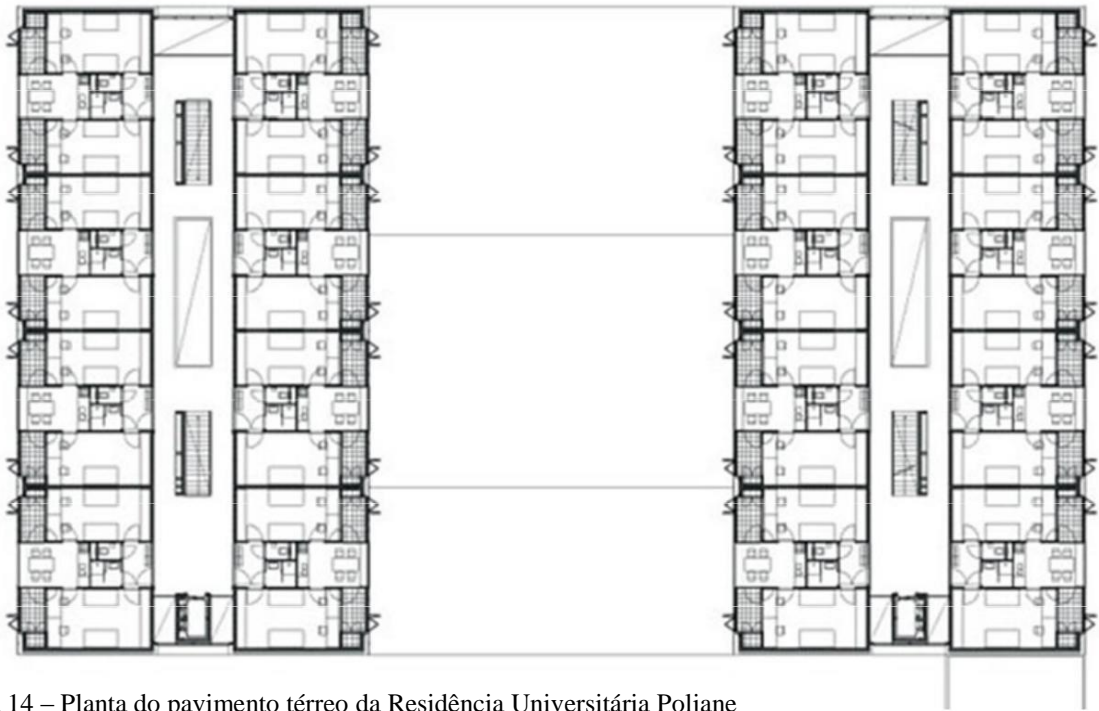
Planta do pavimento térreo da Residência Universitária Poljane
